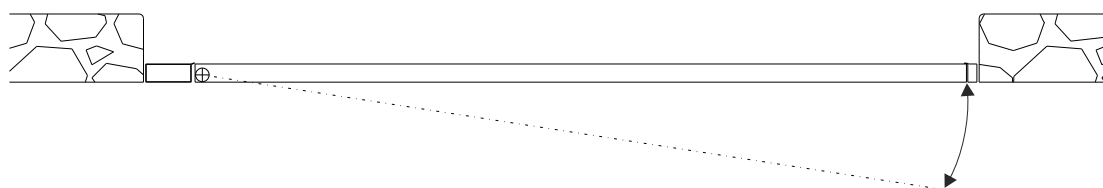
Detalle en planta de puerta industrial batiente cancela de 1 hoja.
